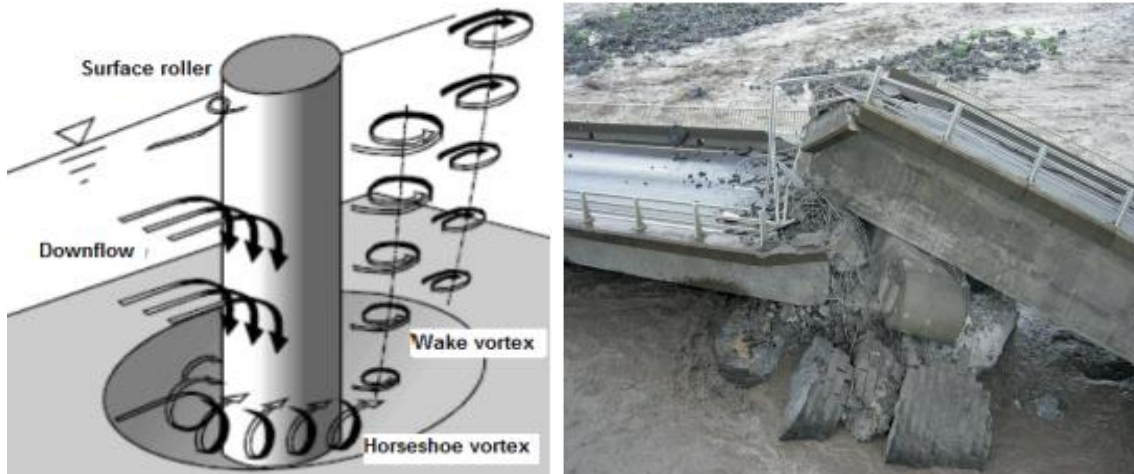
Exemple d'affouillement local : (a) l'écoulement autour d'une pile cylindrique; (b) l'effondrement du pont sur la rivière Saint-Étienne, 2007 (Source : Cerema 2019)
